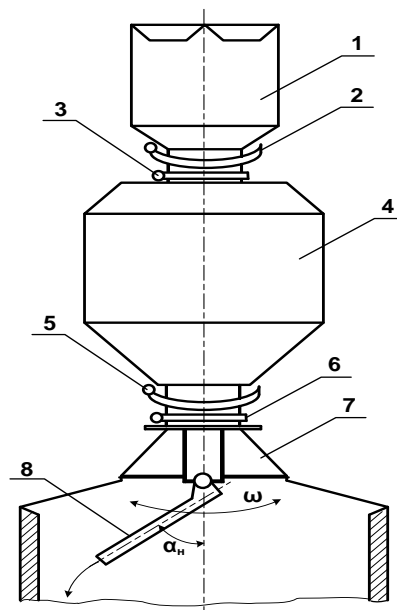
Конструктивные элементы БЗУ (1,4 – приемный и шихтовый бункера; 2,3 – верхние шихтовый затвор и уплотнительный клапан; 5,6 – нижние шихтовый затвор и уплотнительный клапан; 7 – редуктор; 8 – лоток)
